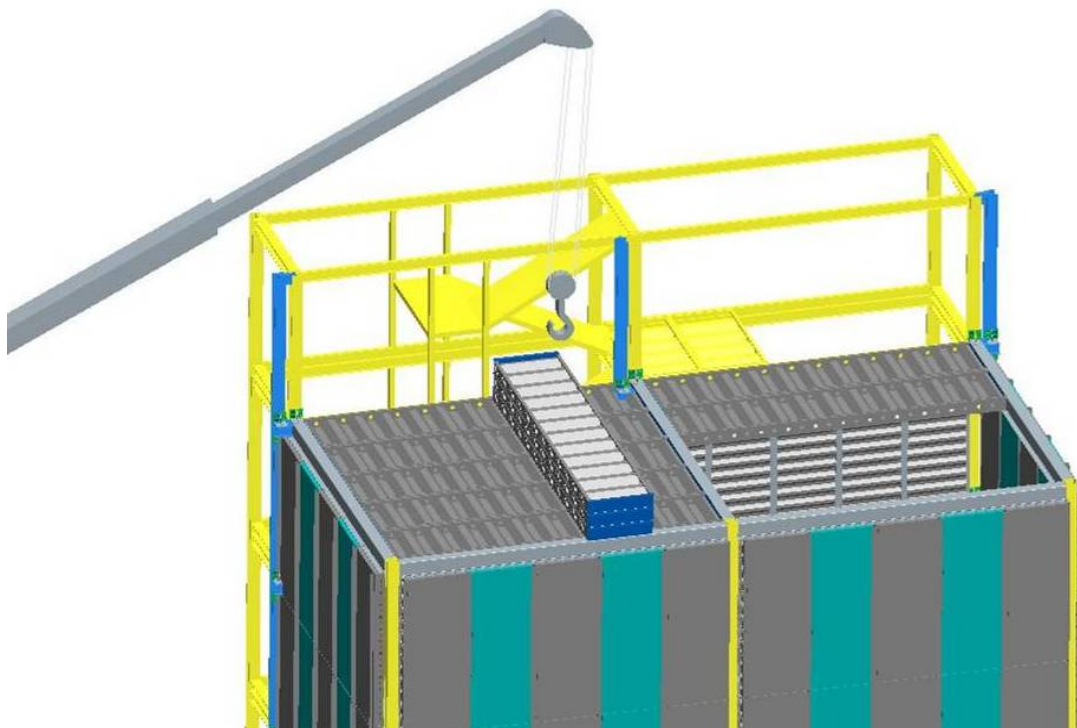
Desmontaje y paletizado de UCAs de cubierta
